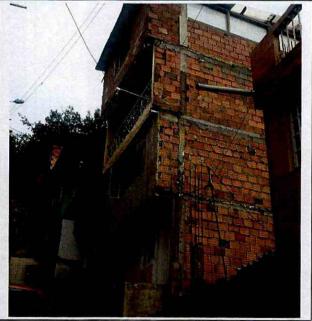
Vista frontal vivienda emplazada en predio 2. Fotografía tomada el 17/04/2018
